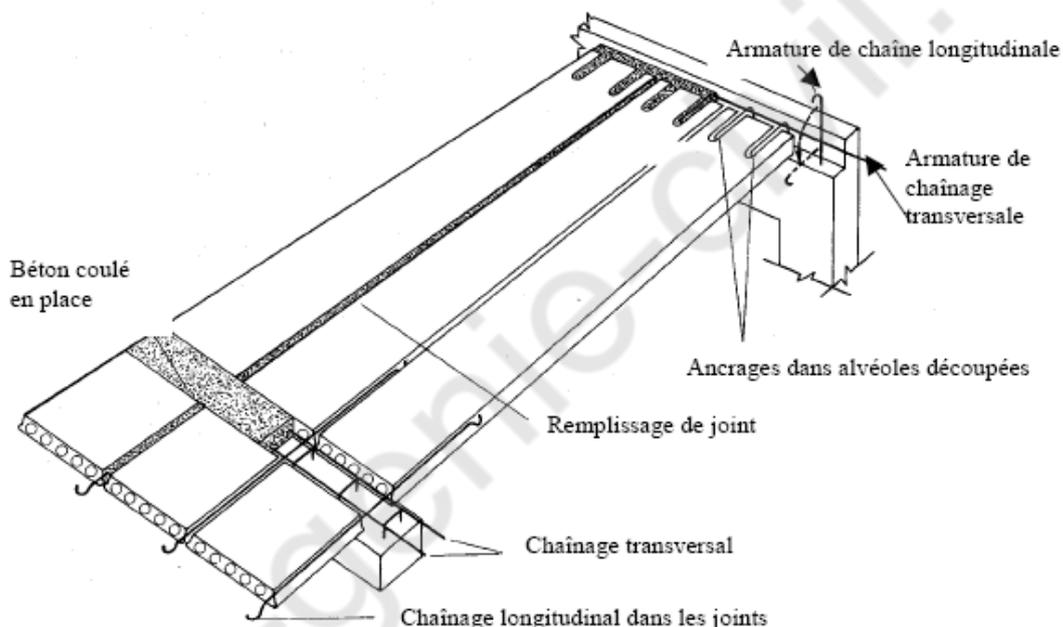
Ancre d'armatures de chaînage longitudinales dans des planchers alvéolés
